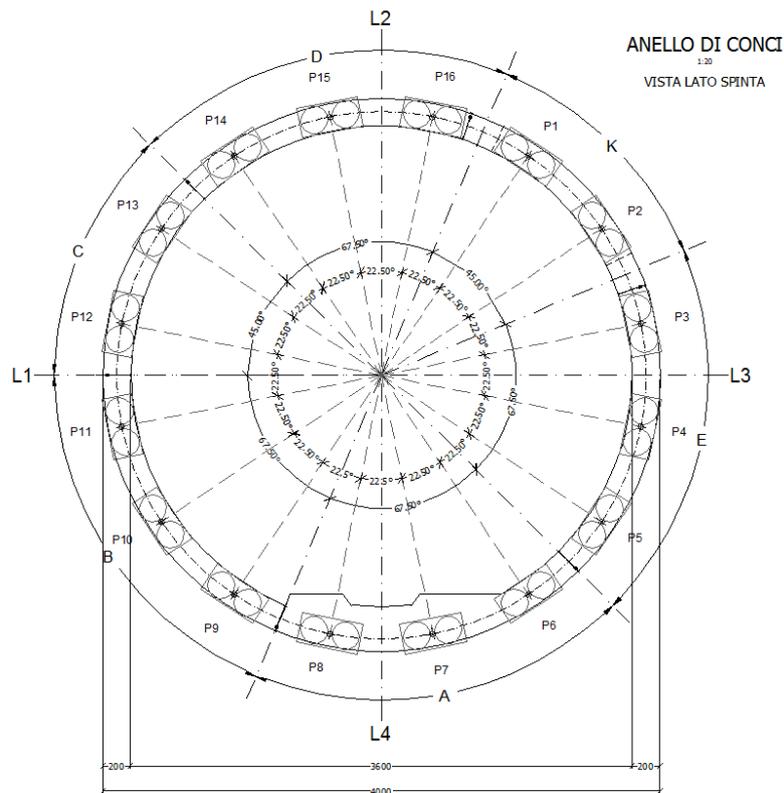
Geometria tipo dell'anello di conchi prefabbricati
